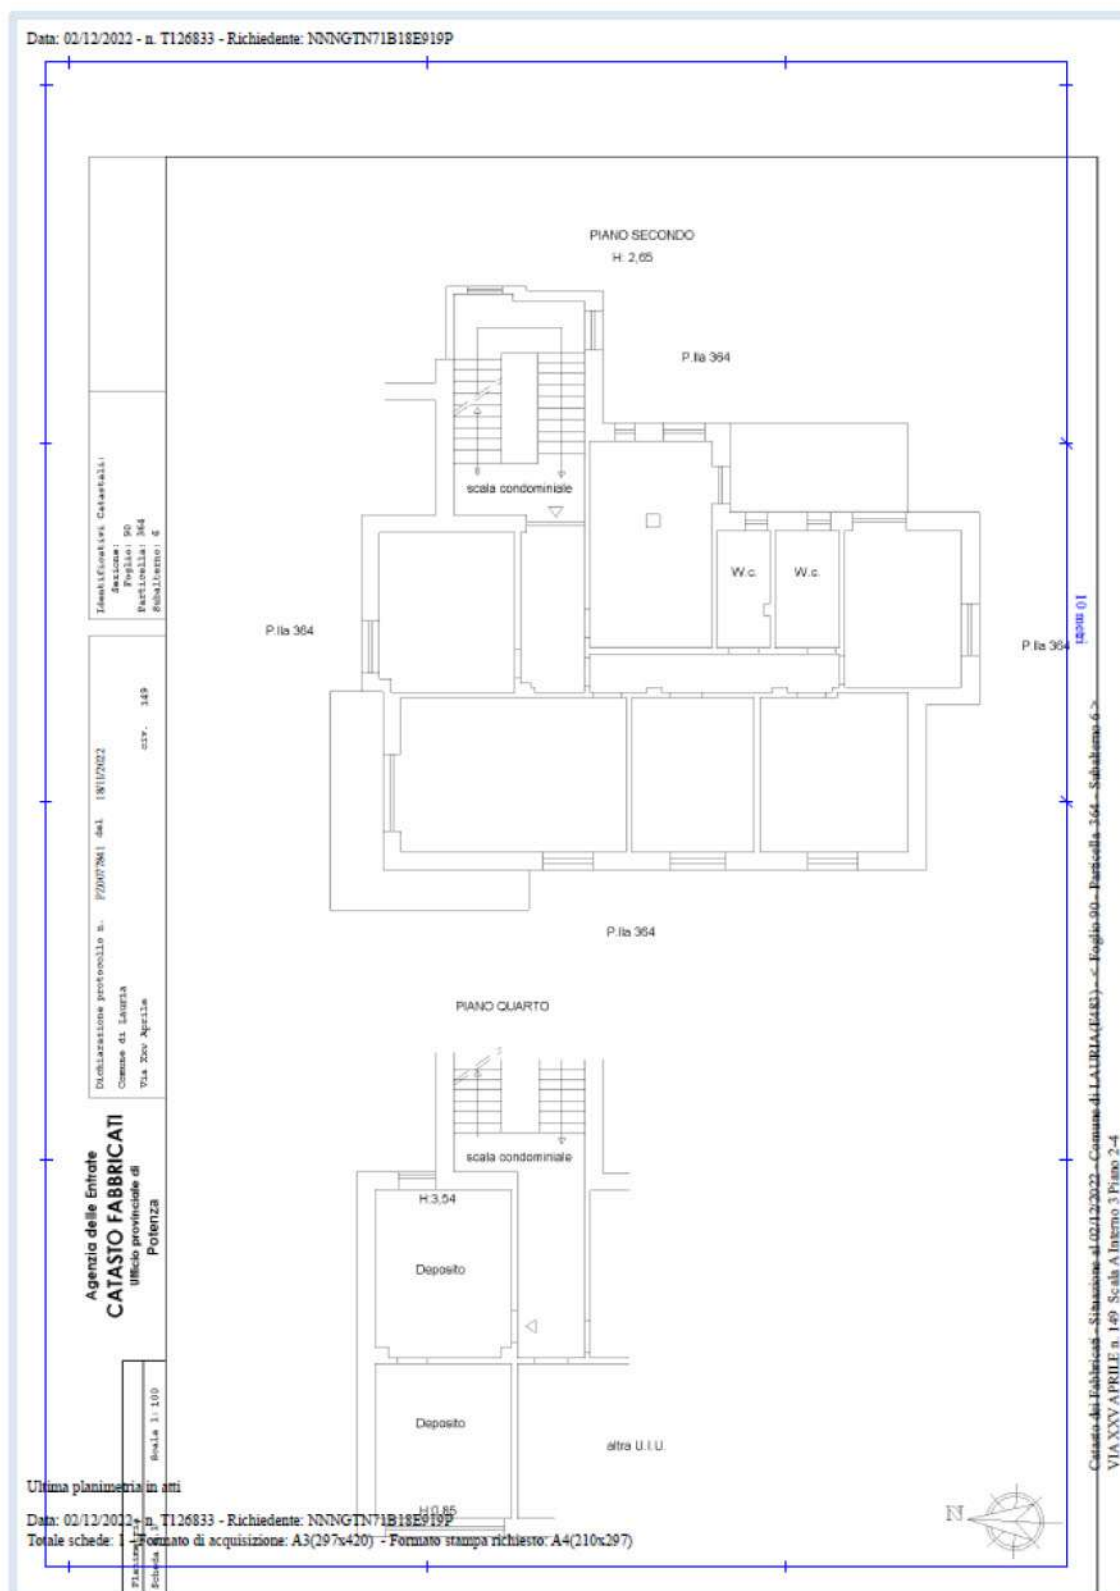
Planimetria “aggiornata” Unità Fg. 90 P.lla 364 sub. 6
